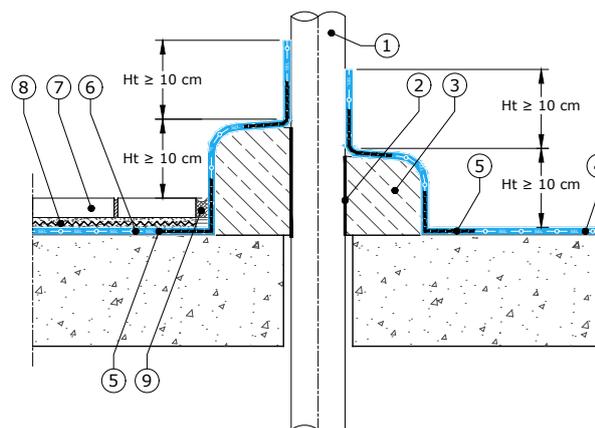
Exemple de traversée d'une canalisation existante sur massif sans fourreau
